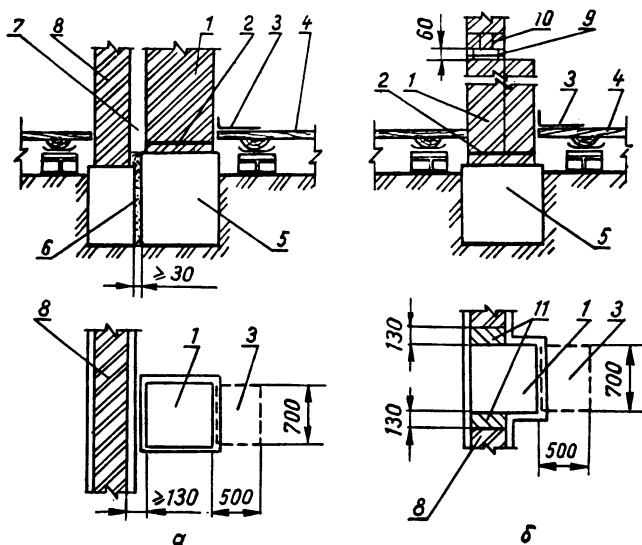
Основания под печи, располагаемые в нижнем этаже здания:
